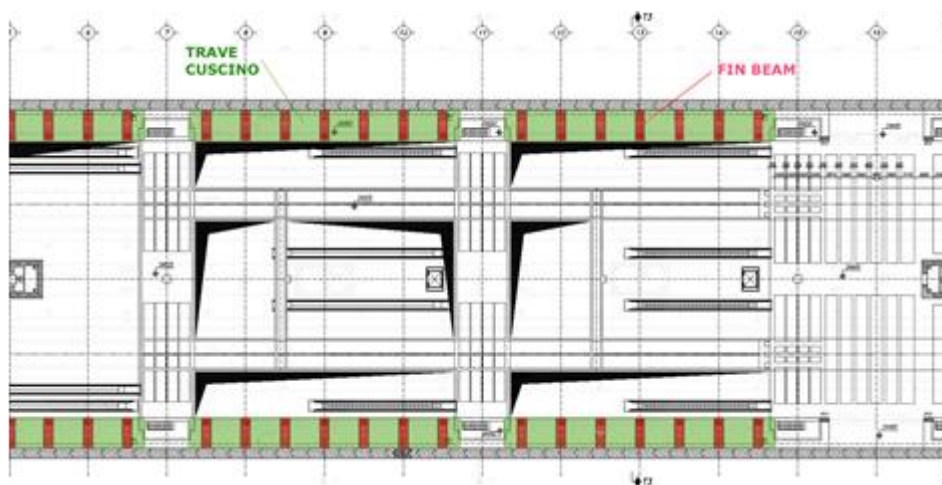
Camerone – Pianta livello Mezzanino – Stralcio picchetti 5-17
